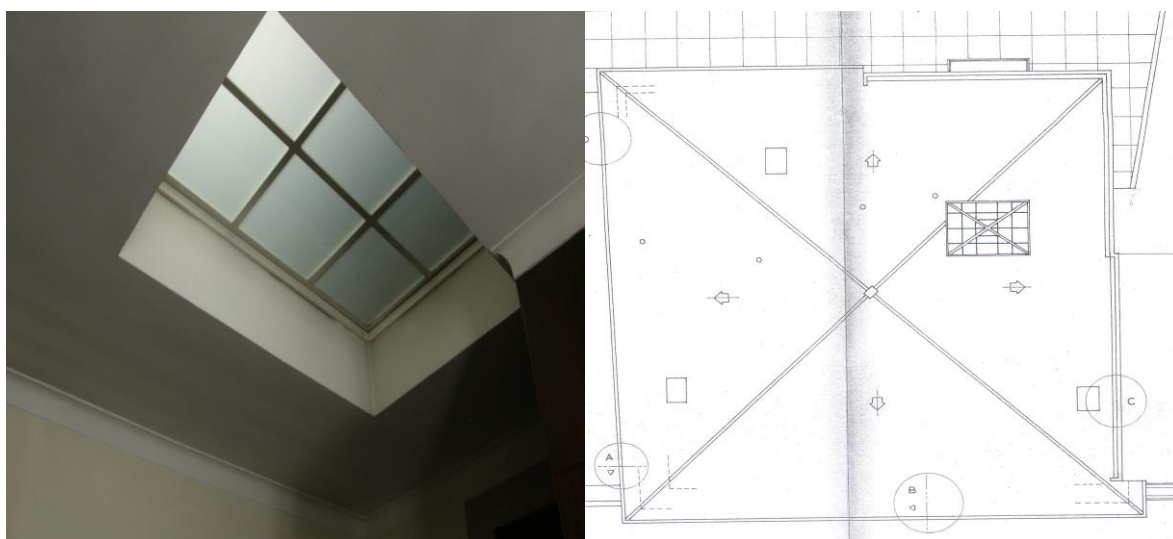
e 18 – Clarabóia envidraçada no 1º piso e representação na planta de cobertura
